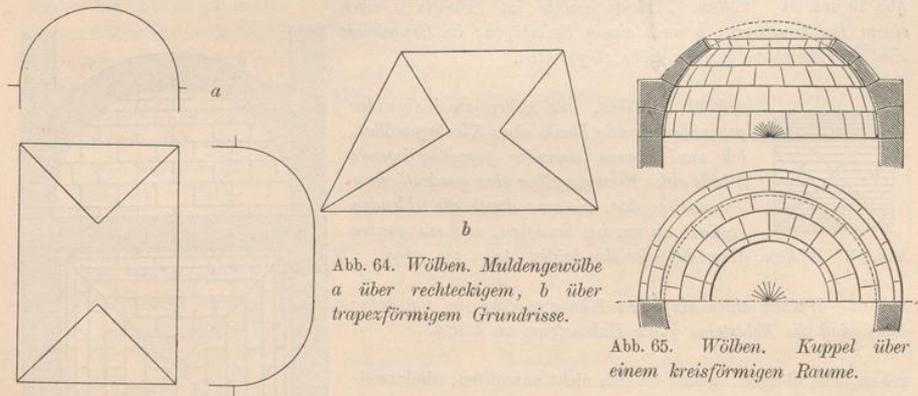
Wölben. Muldengewölbe a über rechteckigem, b über trapexförmigem Grundrisse.
